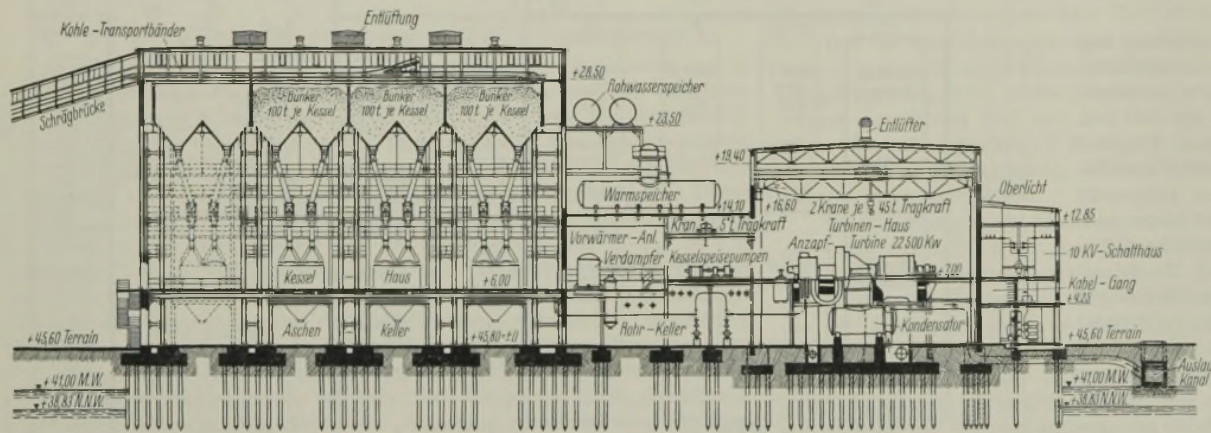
Schnitt durch Kesselhaus, Vorwärmanlage, Maschinen- und 10-kV-Schaltheis.
